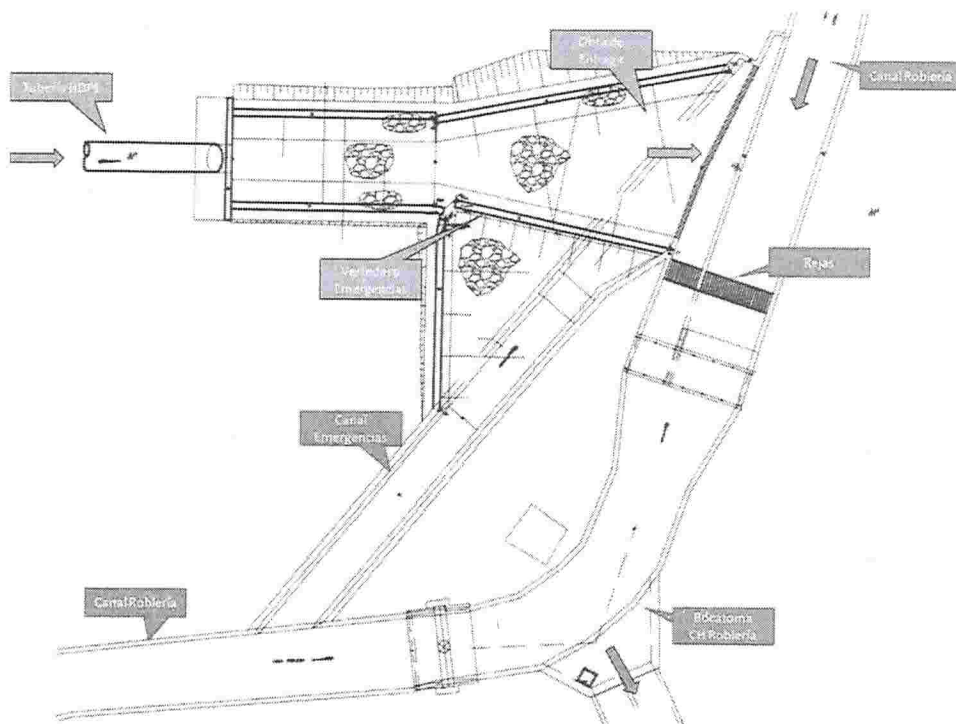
Esquema en planta de la obra de entrega al Canal Roblería (en azul obras existentes de la CH Roblería y en verde las obras proyectadas de la Aducción Nacimiento).
